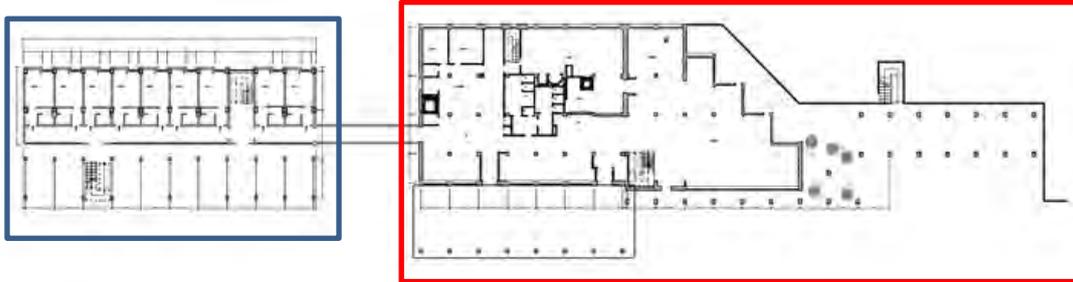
pianta del piano terra dell'hotel San Faustino. Evidenziato in blu il blocco camere e in rosso il blocco centrale dell'Hotel
